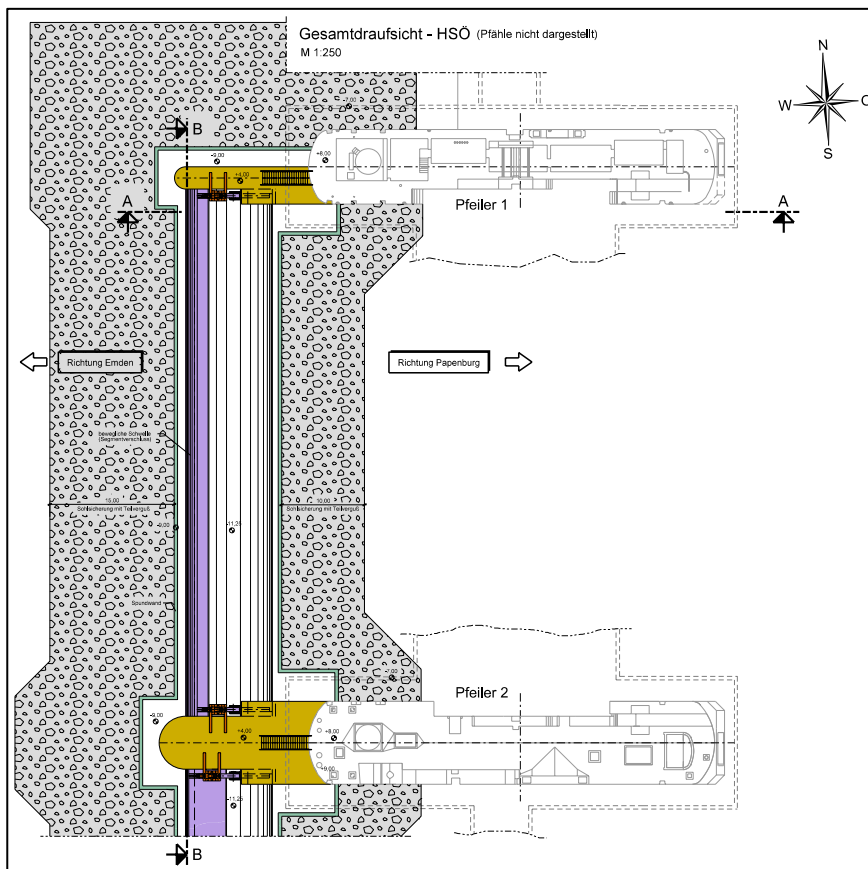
Grundriss, bewegliche Schwelle in Klappenbauweise
